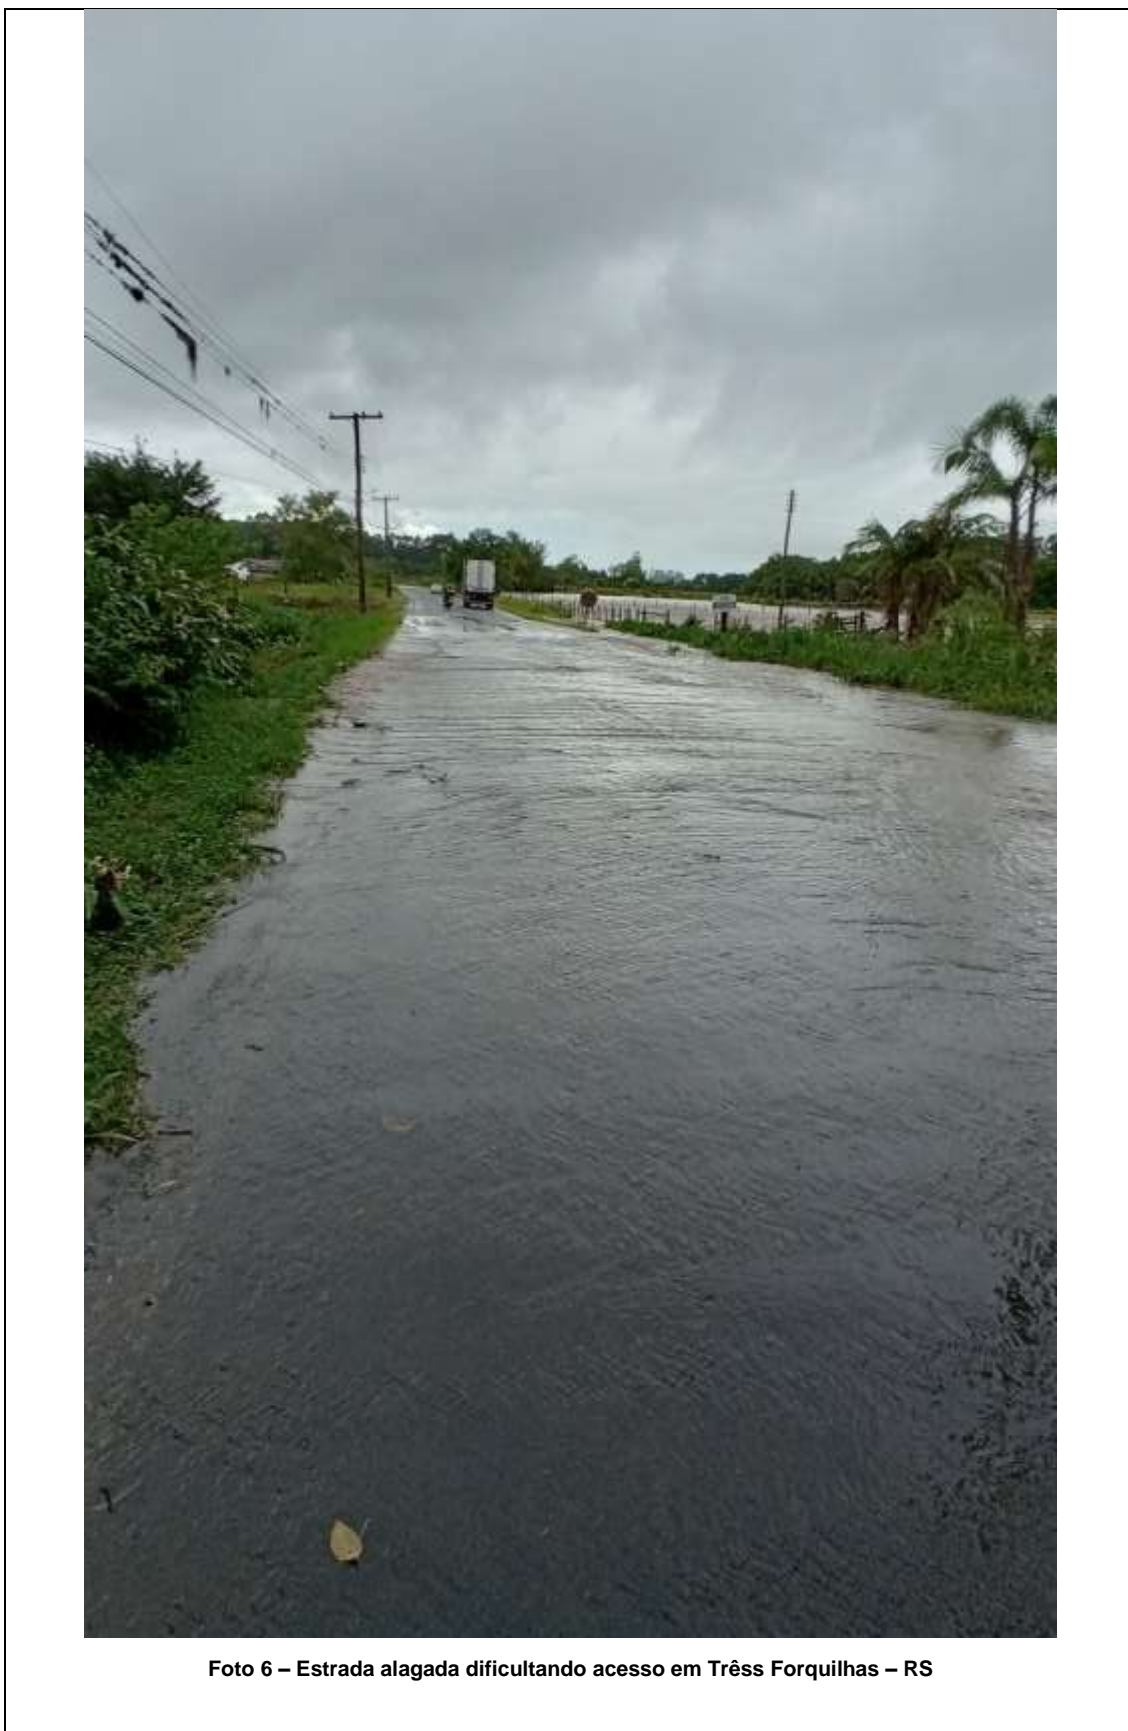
Estrada alagada dificultando acesso em Três Forquilhas – RS
